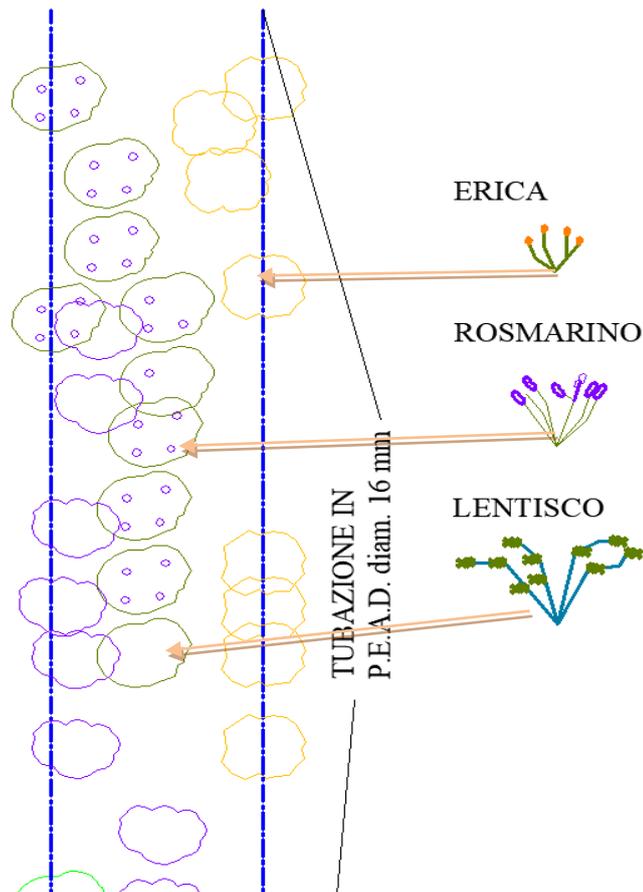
Pianta esempio fascia di mitigazione, le plantule verranno distribuite secondo un sesto irregolare.
